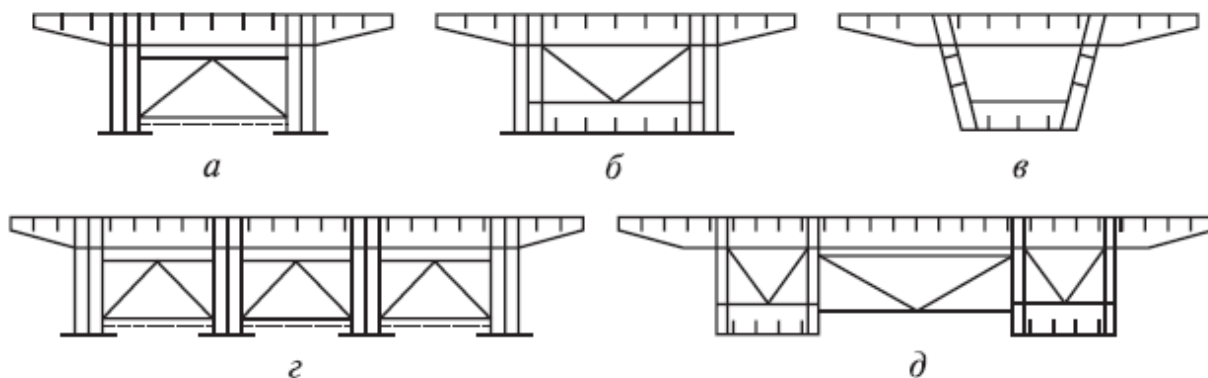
Типы (а—д) поперечных сечений пролетных строений со сплошными балками
